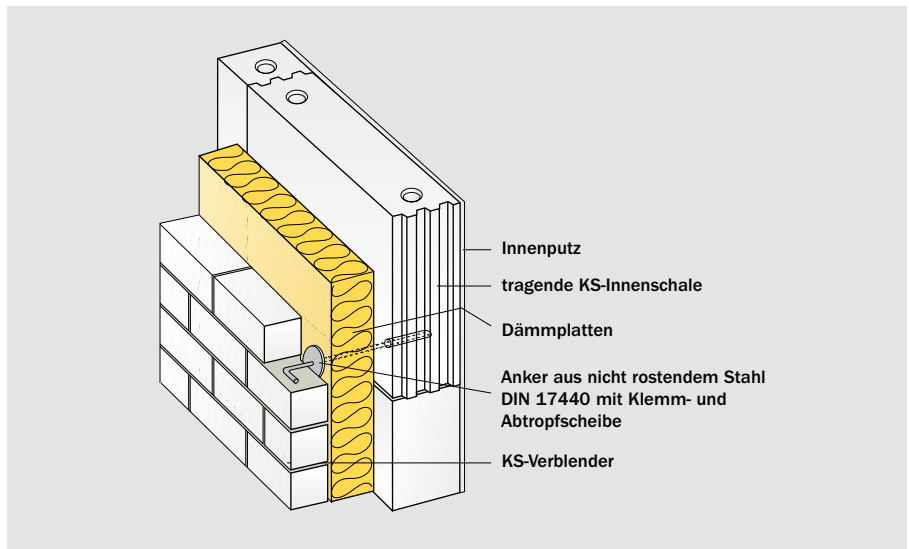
Systemaufbau zweischaliges Mauerwerk mit Kerndämmung
